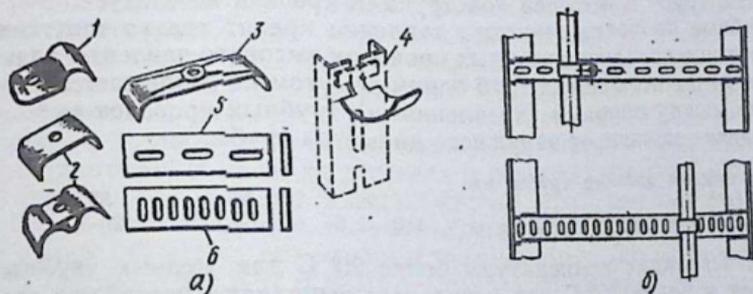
Детали для крепления труб и кабелей (а) и крепление трубных проводов на мостике с перфорацией (б):
